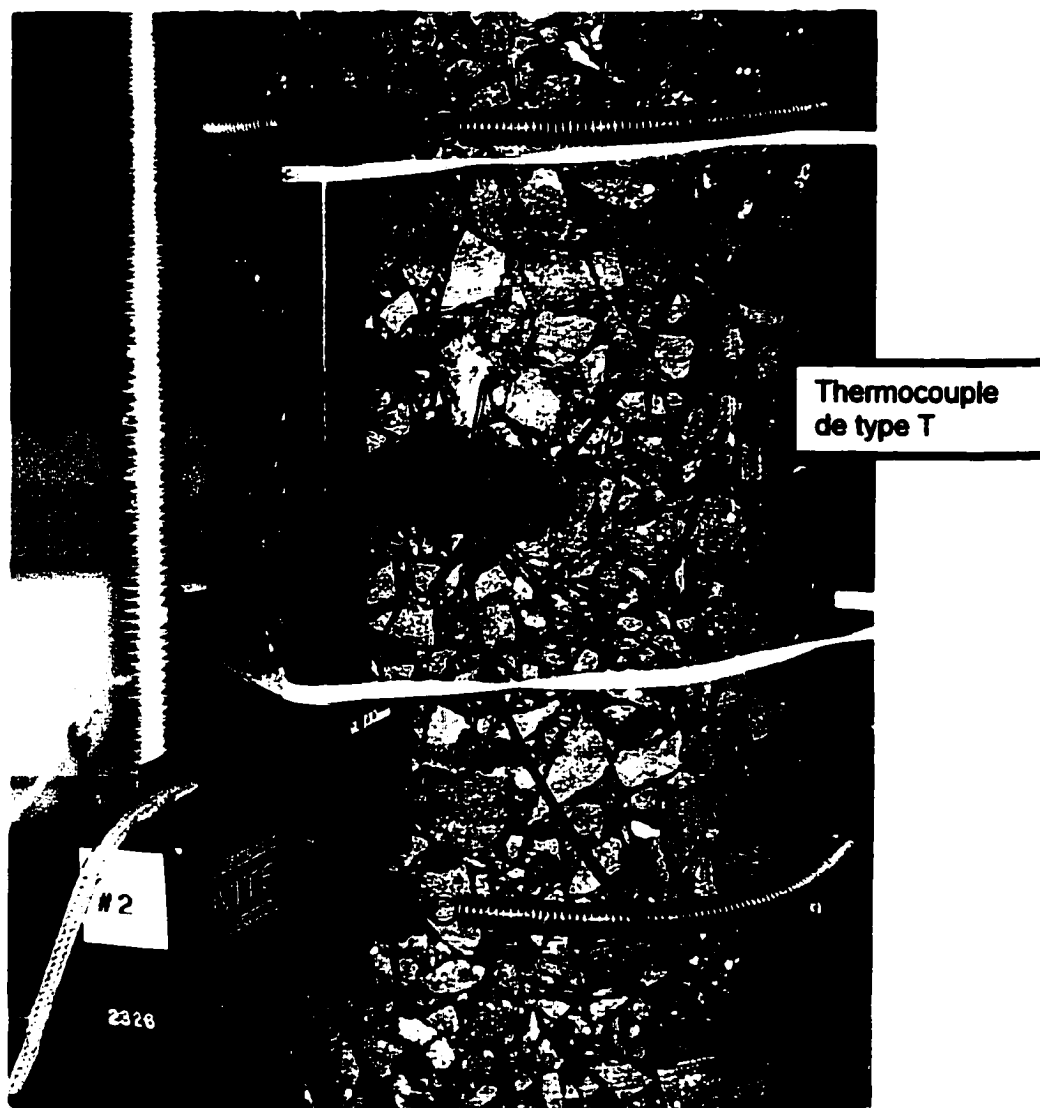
Thermocouple collé à la surface d'une éprouvette
